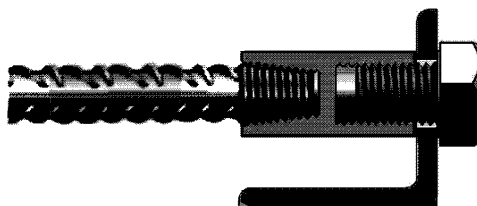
Резьбовое соединение арматуры под метрический болт
